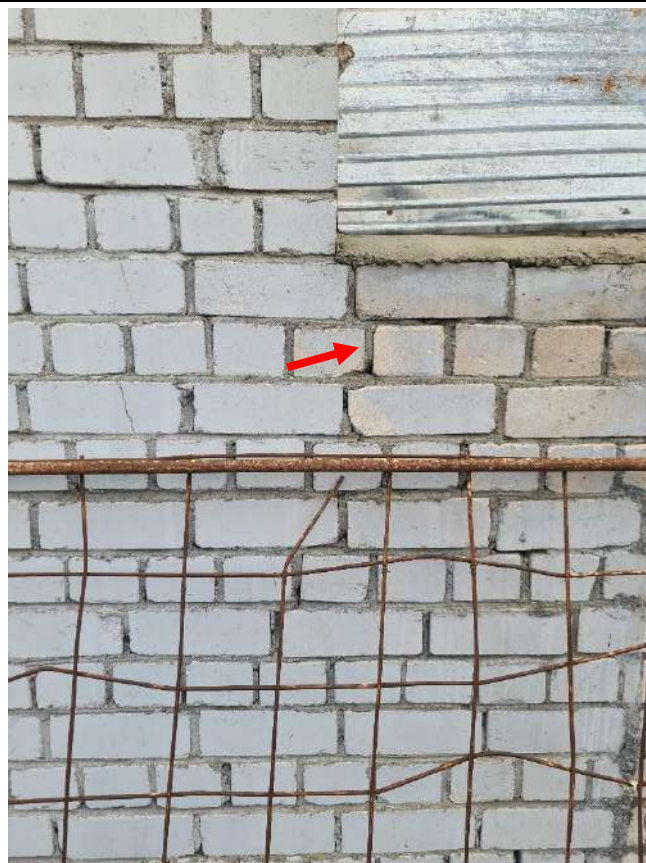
Трещины кирпичной кладки наружной стены в осях 3-2/Д
